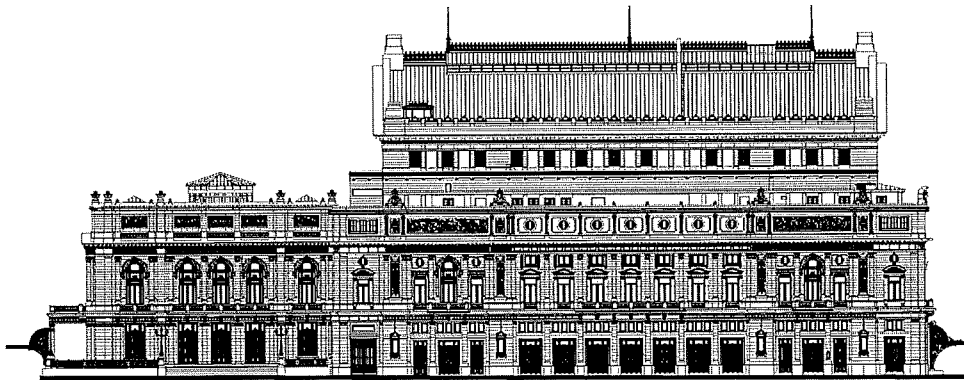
Fachada del Colón sobre calle Tucumán.
